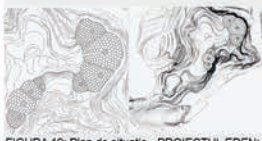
Plan de situație - PROIECTUL EDEN: "THE BIOMES"
